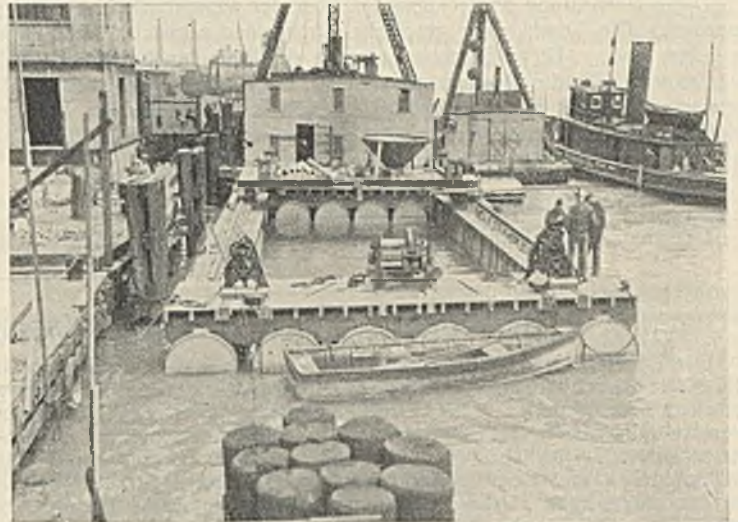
Die Anlage zum Abgleichen des Sandbettes, auf dem die Röhren aufsitzen. Vorn Winden, von denen aus Drahtseile zu dem unter dem Wagen sichtbaren Trägerrost führen.
